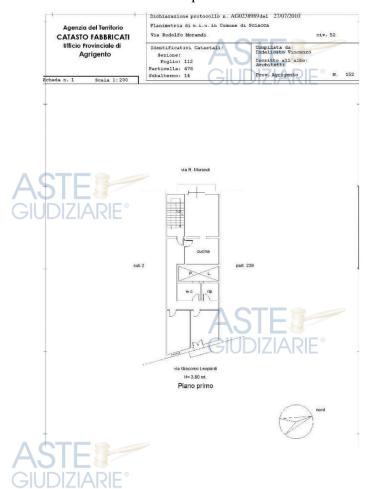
Planimetria Catastale part.lla 478 sub. 14
